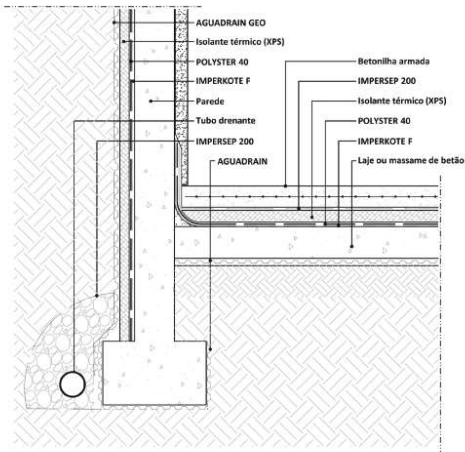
Aplicação dos revestimentos em paredes e pavimentos em contacto com o terreno
